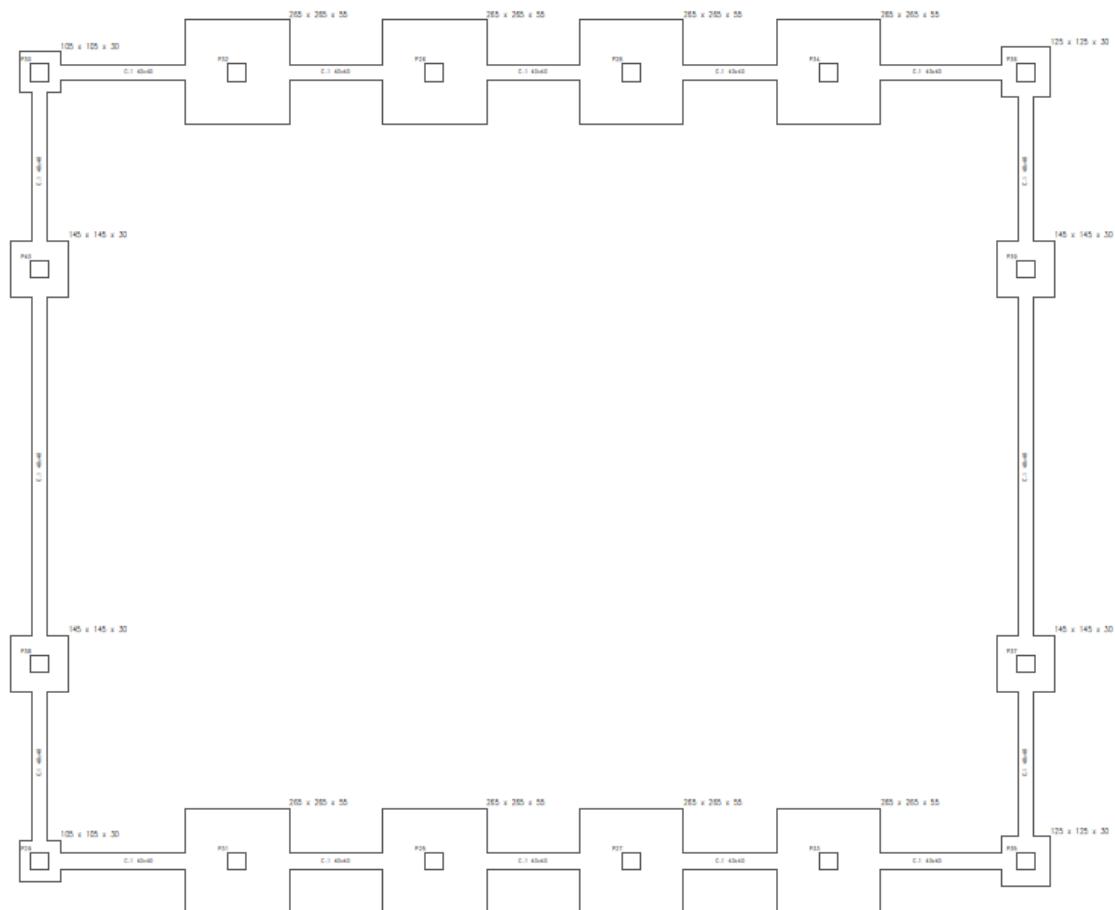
Replanteo cimentación Nave elementos Prefabricados
